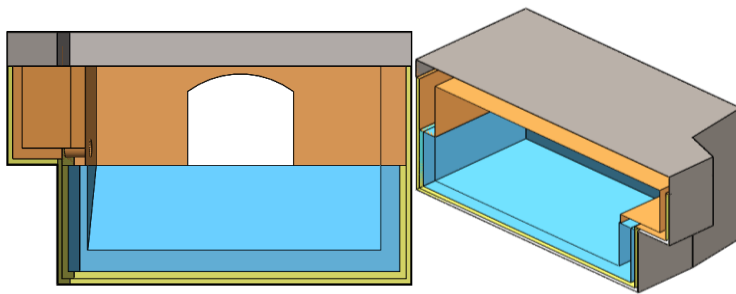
Ensamblaje de la Superestructura en vistas de corte
